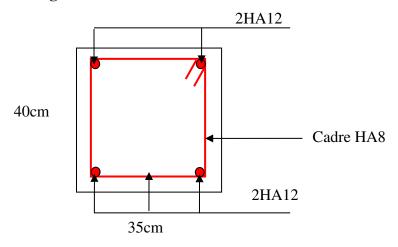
Schéma de ferraillage de la poutre de chainage.
